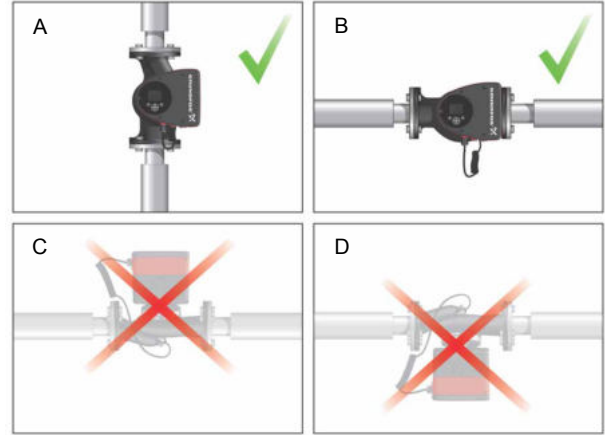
Bomba instalada con el eje del motor en posición horizontal
